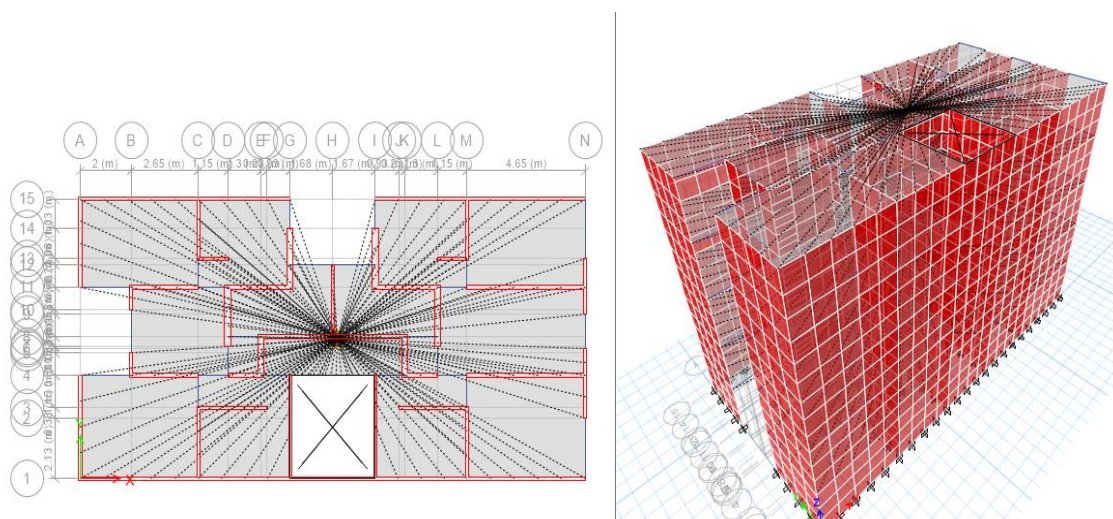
Vista en planta y 3D en el software ETABS de la edificación de albañilería confinada
